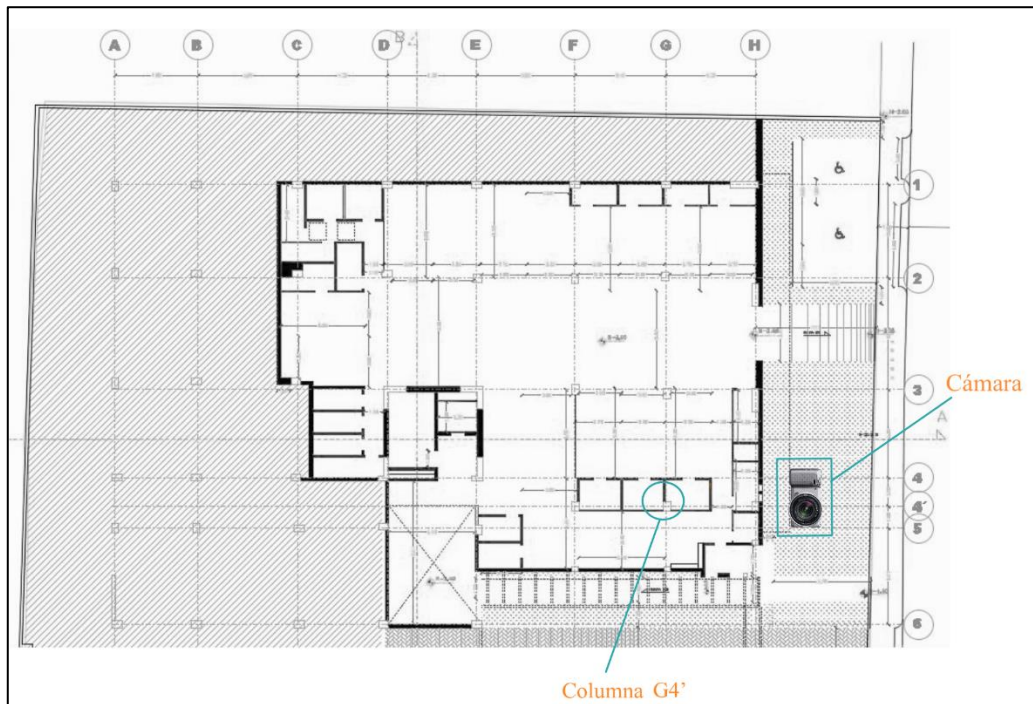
Referencia ubicación cámara y columna a hormigonarse
